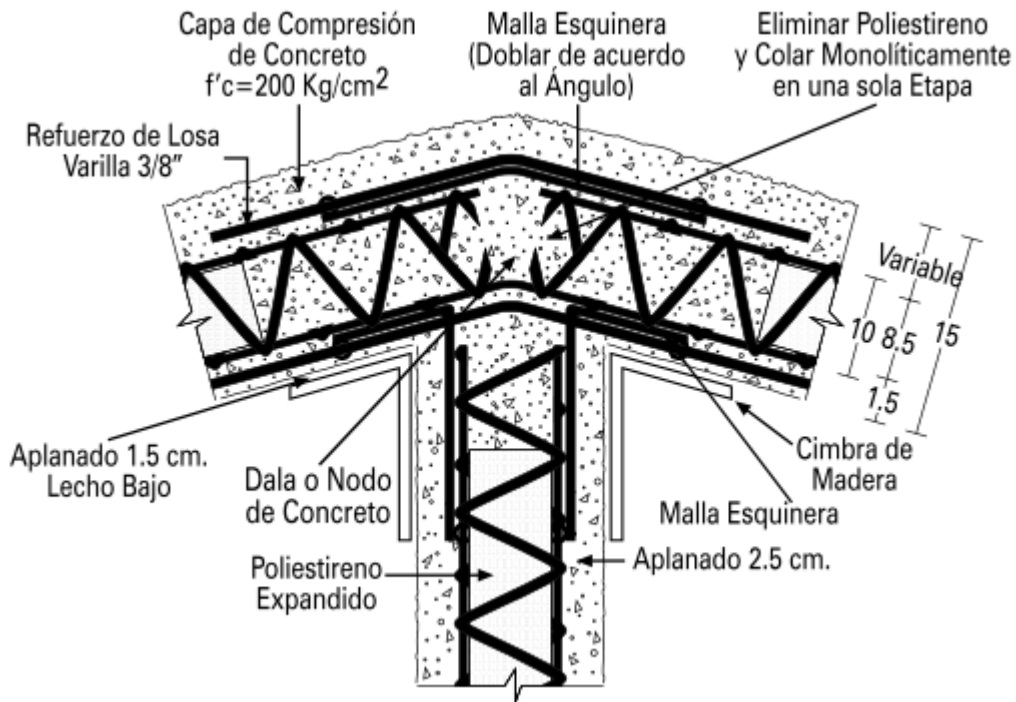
Unión de losa a dos aguas sobre muro de carga.
